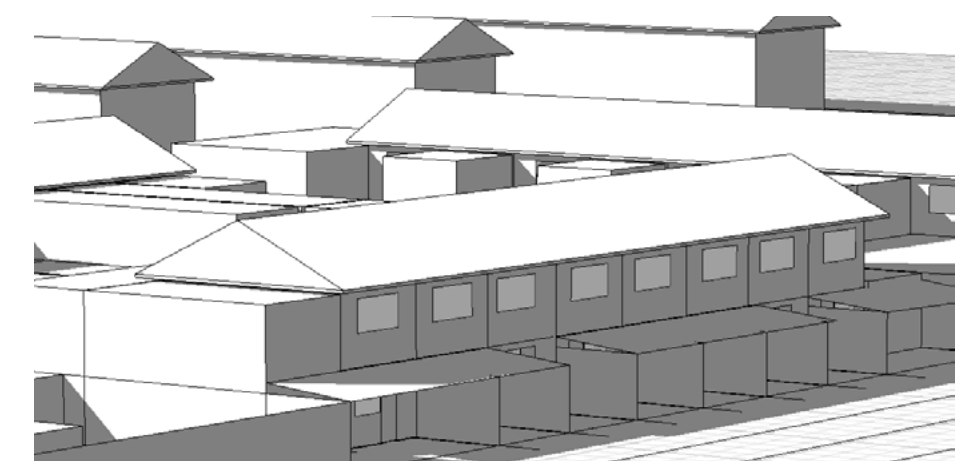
Proyección de sombras para el 21 de Junio a las 15:00hrs, Fachada Sur
